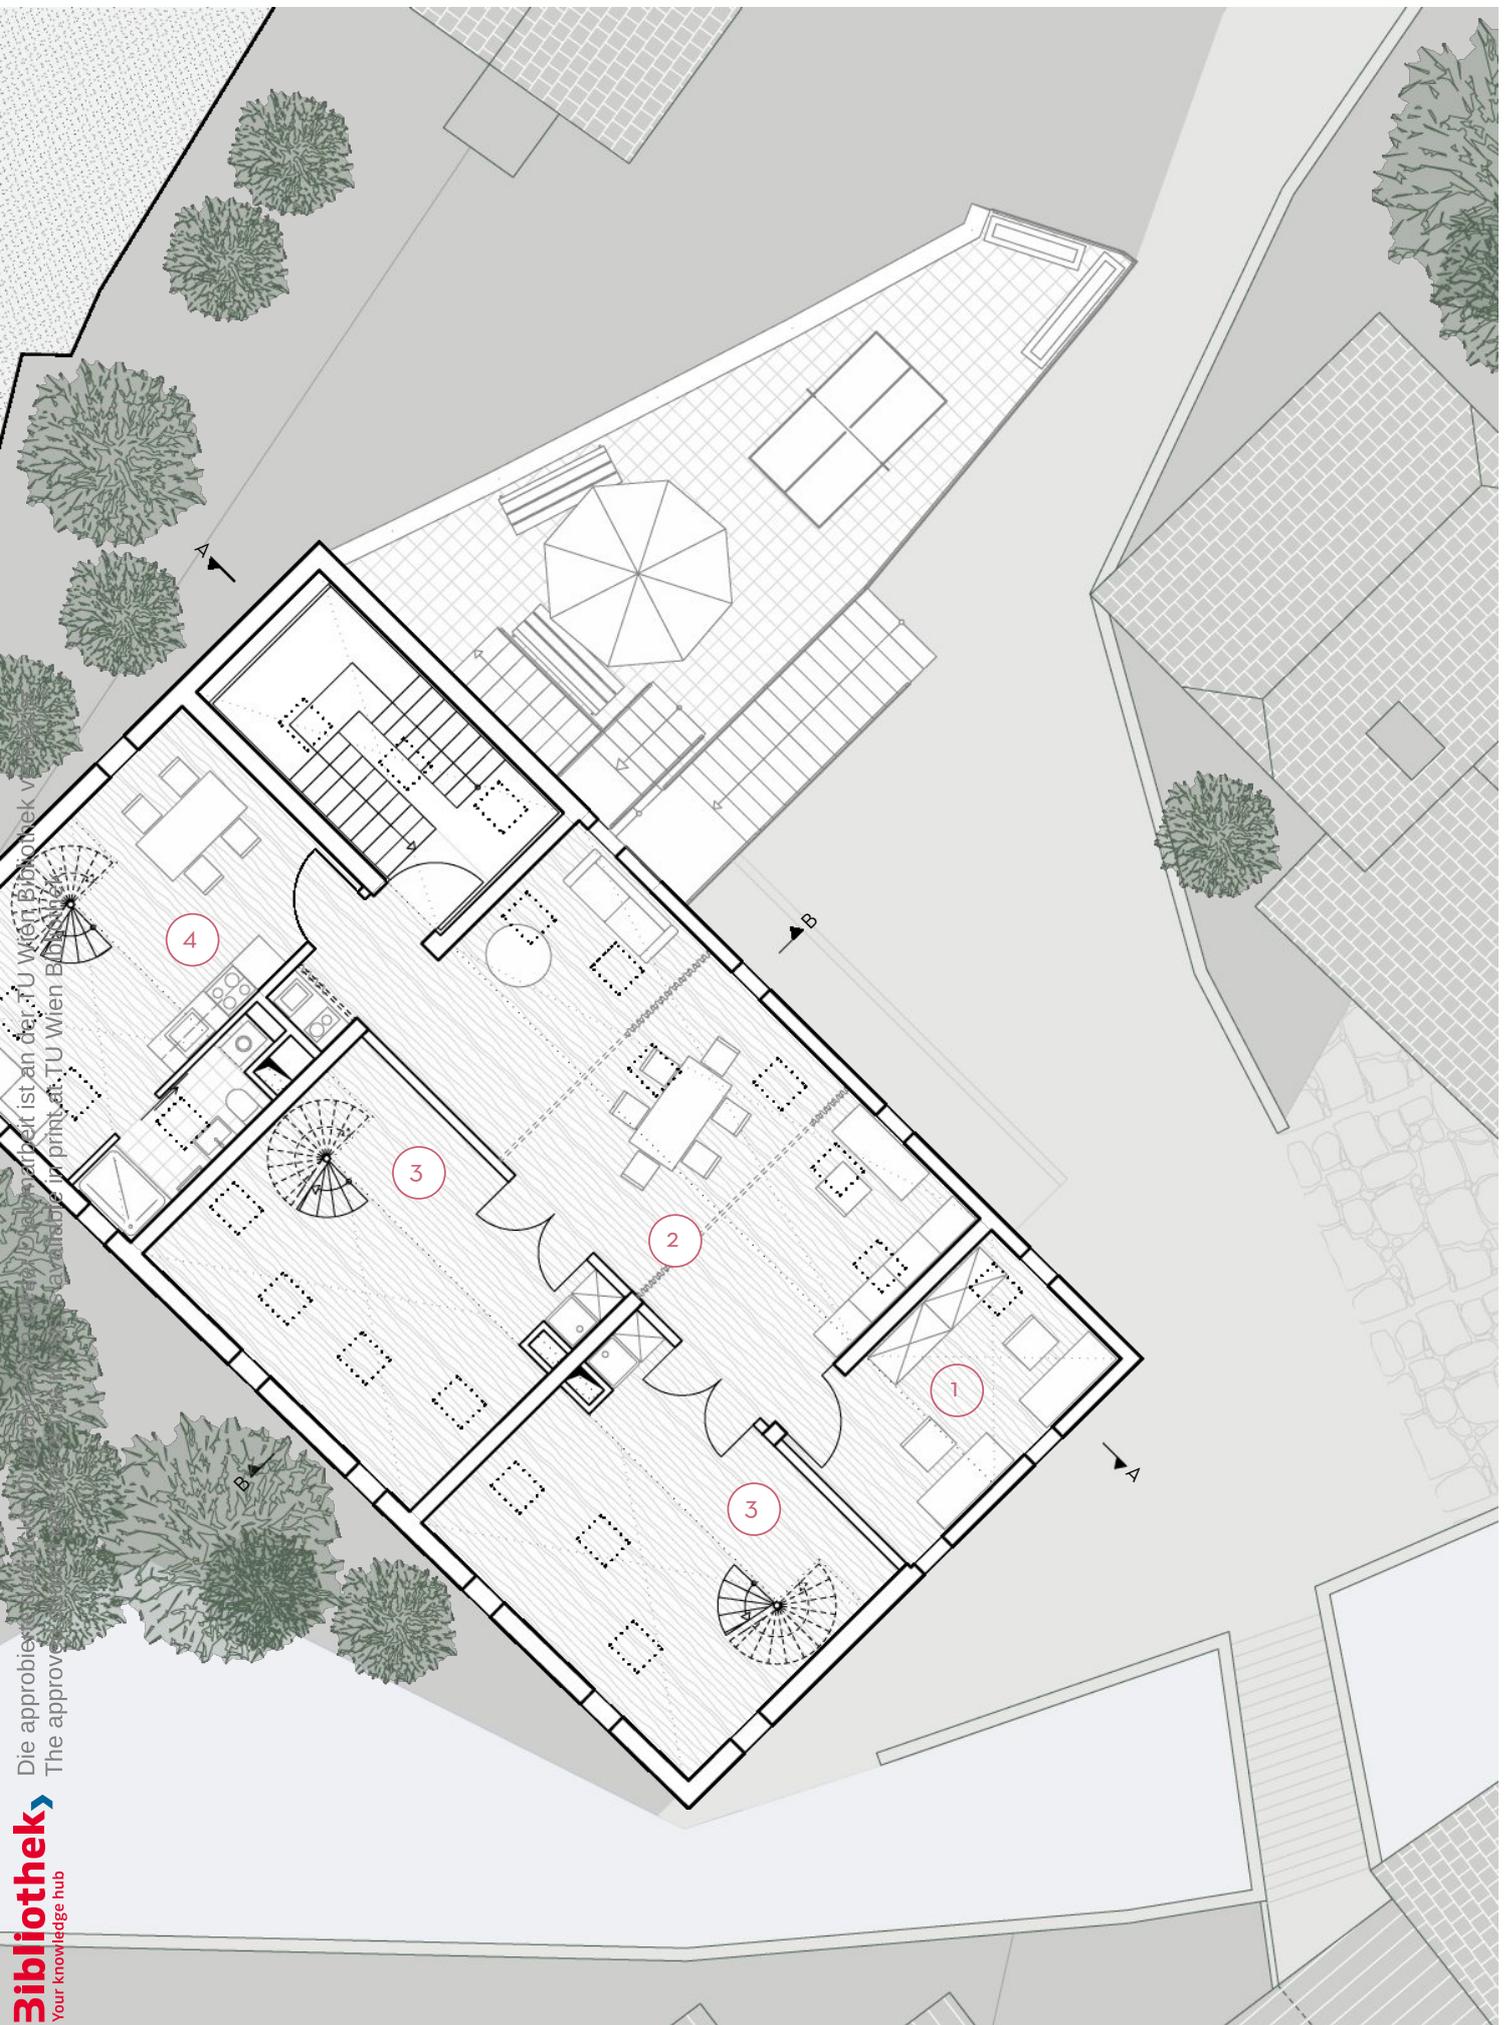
Grundriss 2. Obergeschoss nach Umbau
